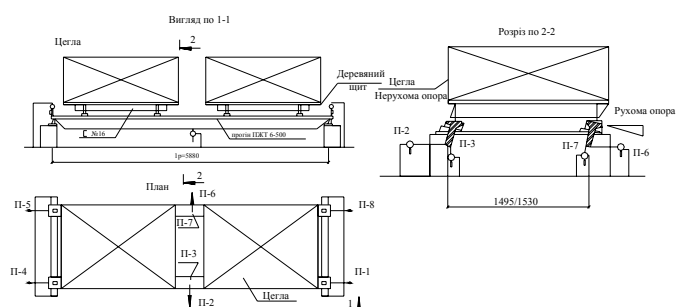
Схема нагрузки и расположения приборов при испытании железобетонных пролетов
